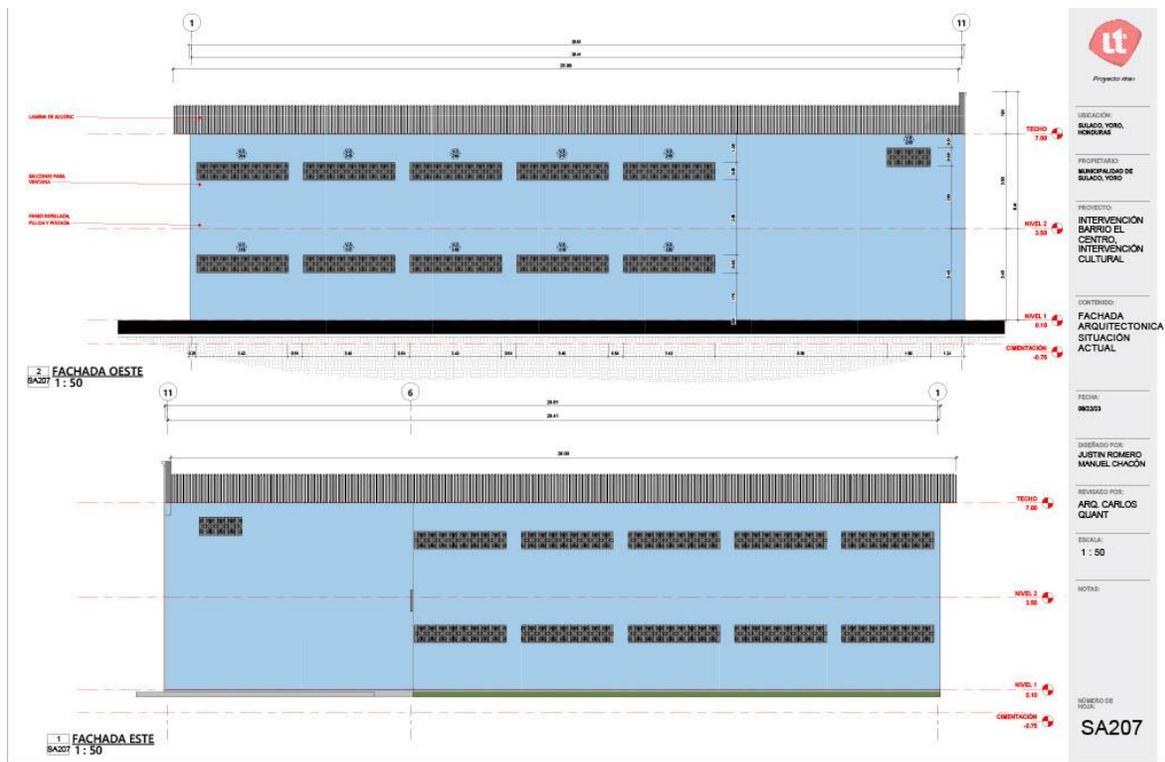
Fachadas | Fuente: Elaboración Propia
